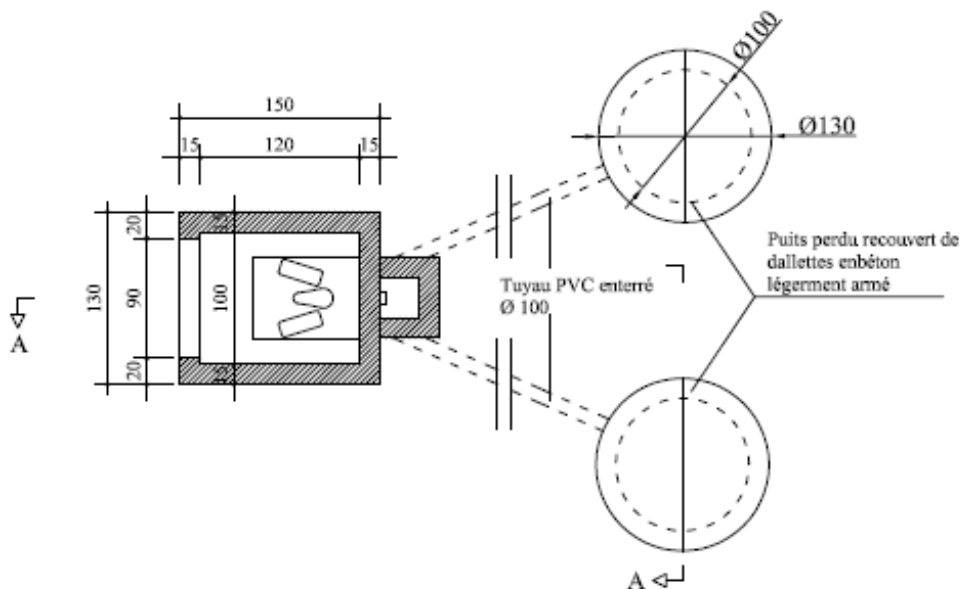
Vue en plan de la toilette à chasse manuelle (TCM)
